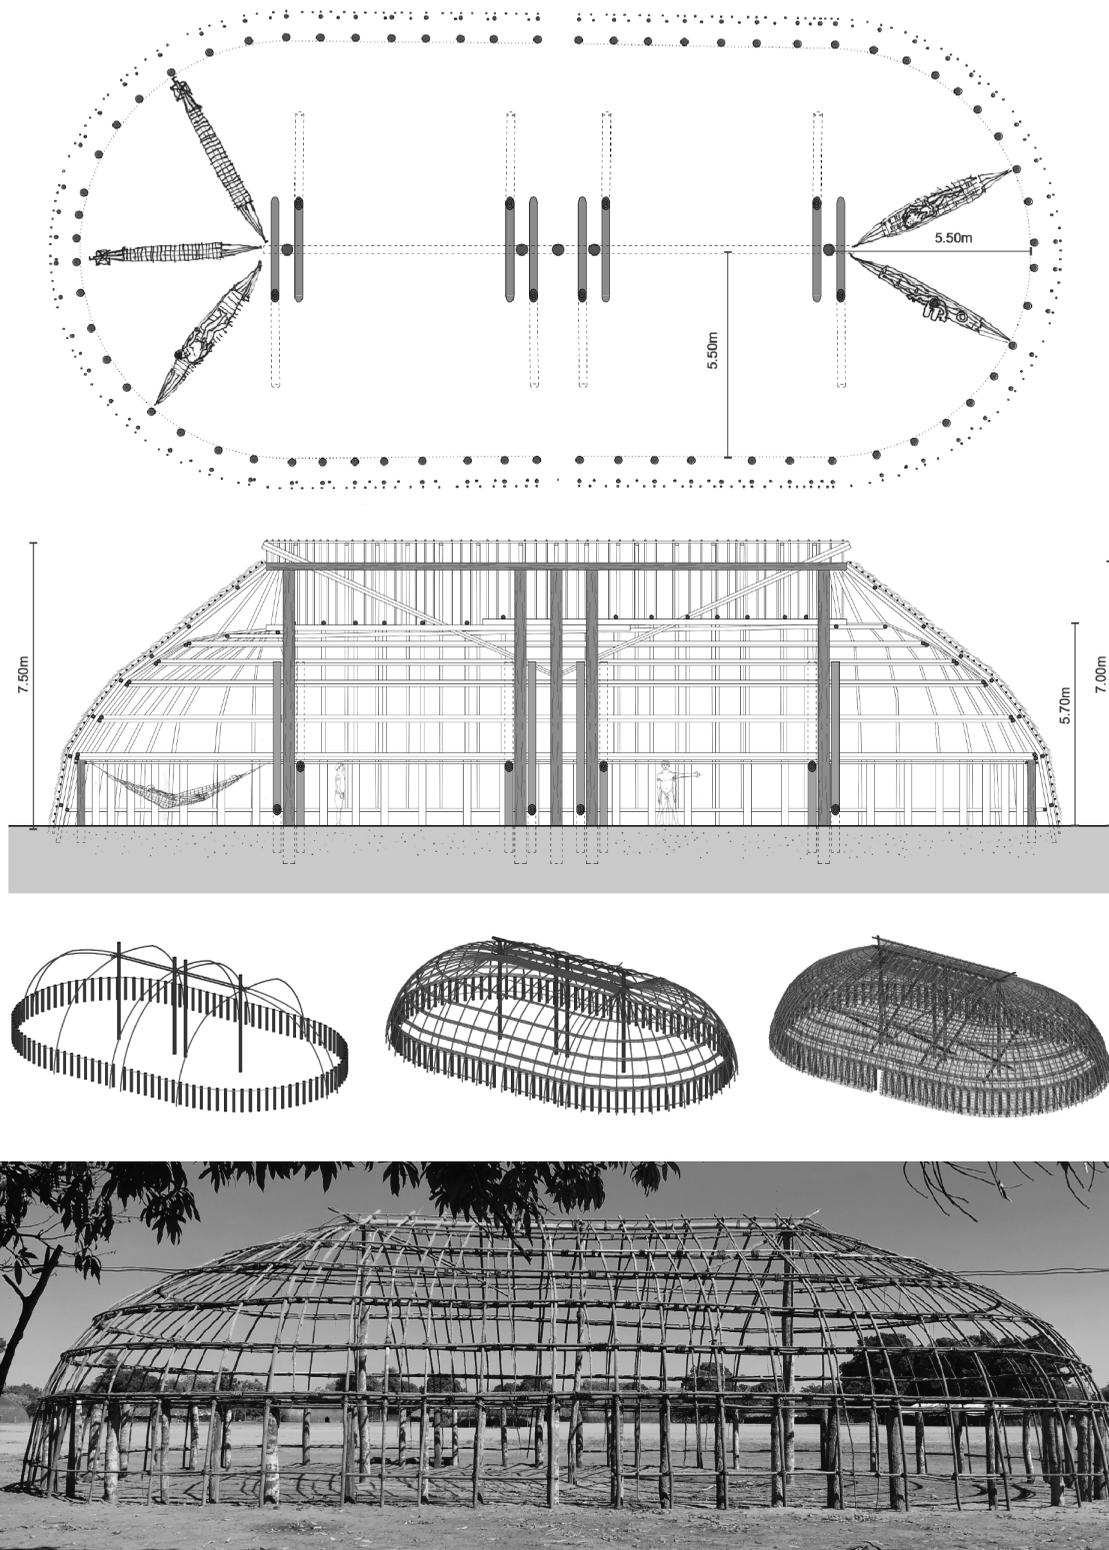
Casa Kamayurá: planta baixa, corte longitudinal, etapas construtivas e casa em construção na aldeia de Ipawu.
